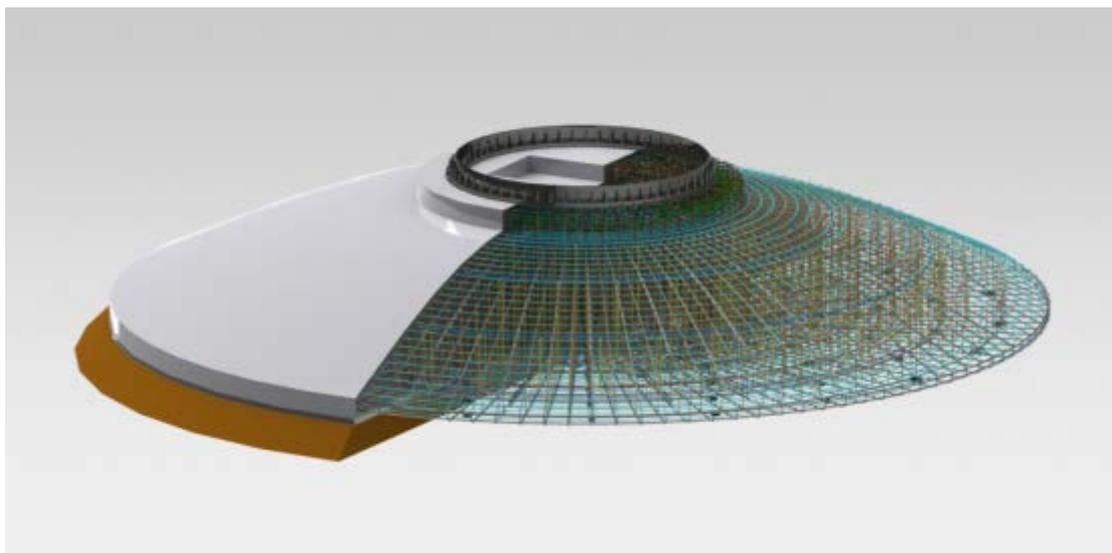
Vista render fondazione Aerogeneratore.
